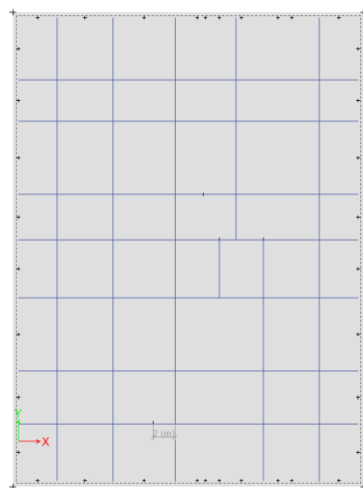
Ferrailage du radier sens y - face TOP RPA2024.
